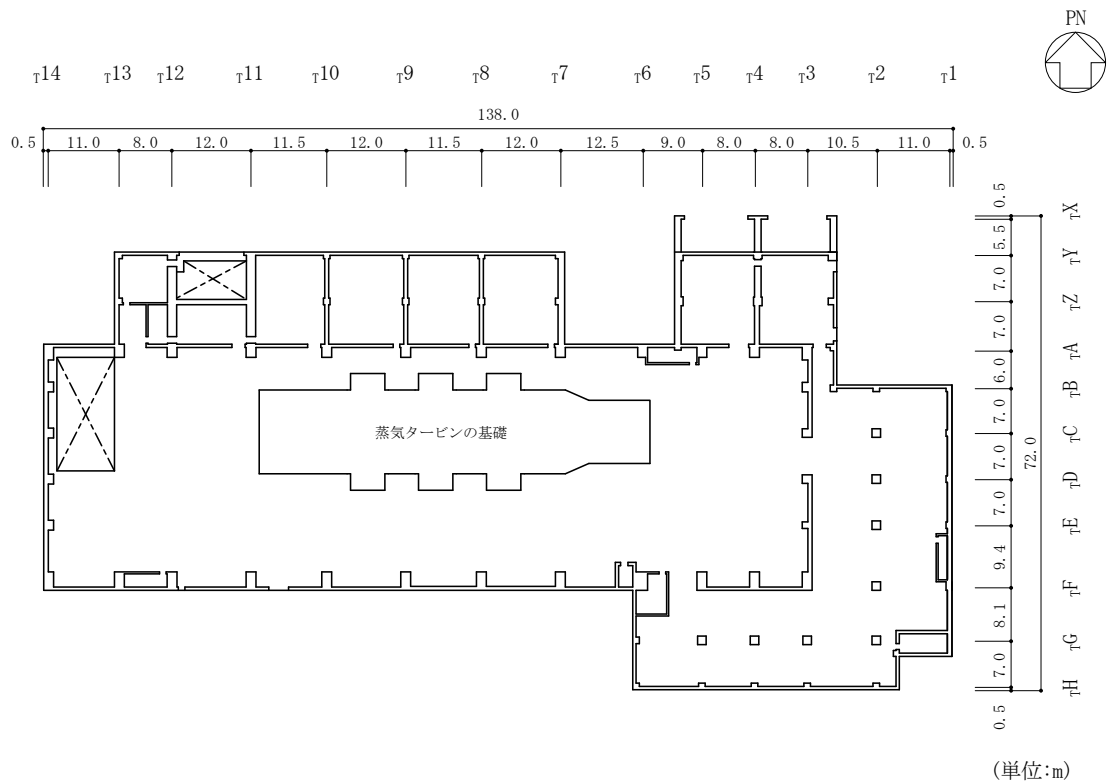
(4) タービン建物の概略平面図 (EL 20.6m)
